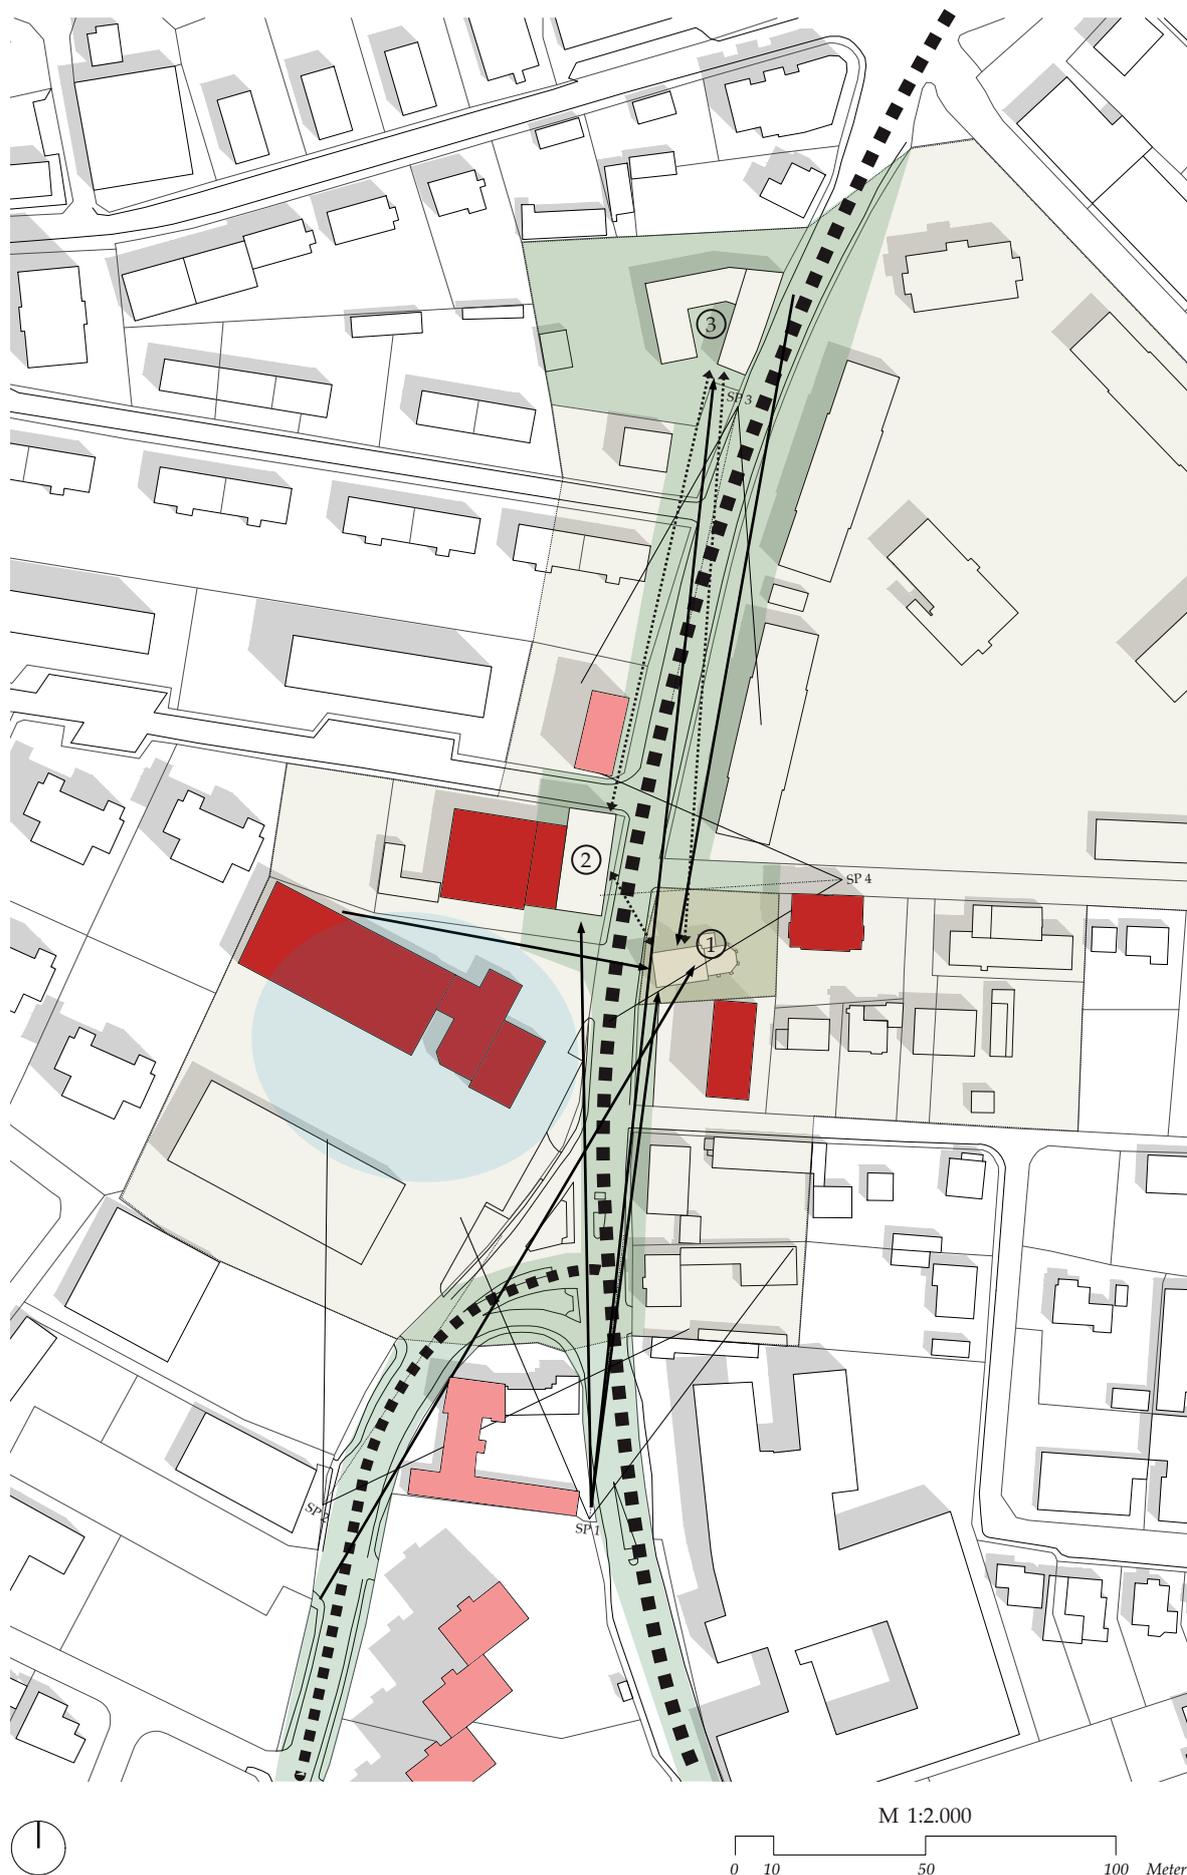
Grundriss Umgebung der Johanneskirche.
